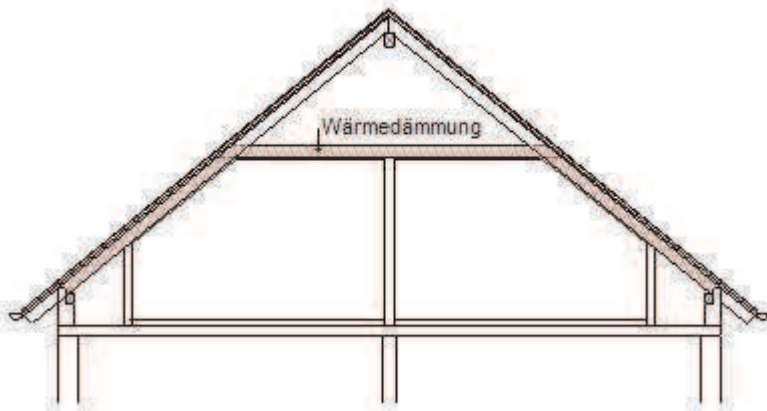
Dach ausgebaut, Dämmung in Kehlbalkebene (Dachgeschossdecke) und Dachschrägen
